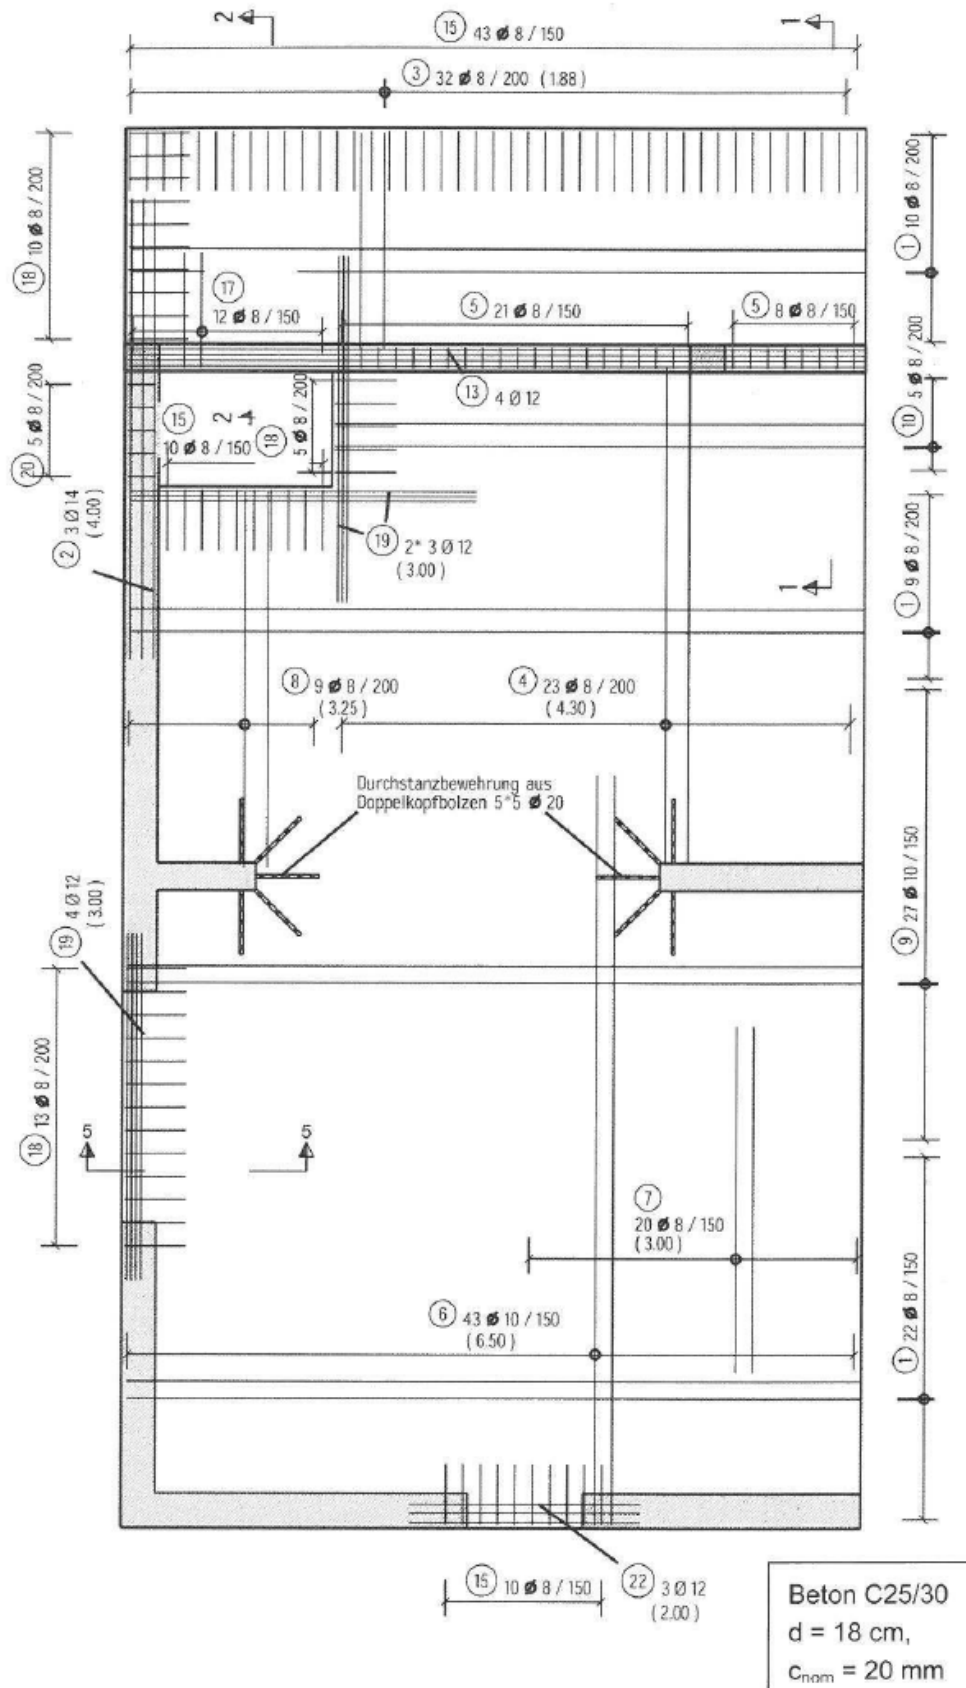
Bewehrungsführung in der Deckenplatte (untere Bewehrung)
